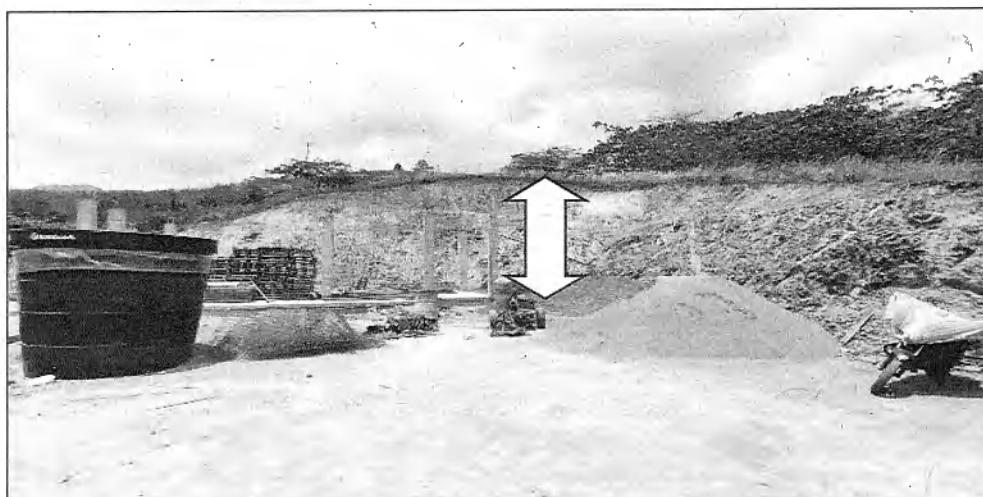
Vista del talud de corte del terreno (Flecha amarilla).
